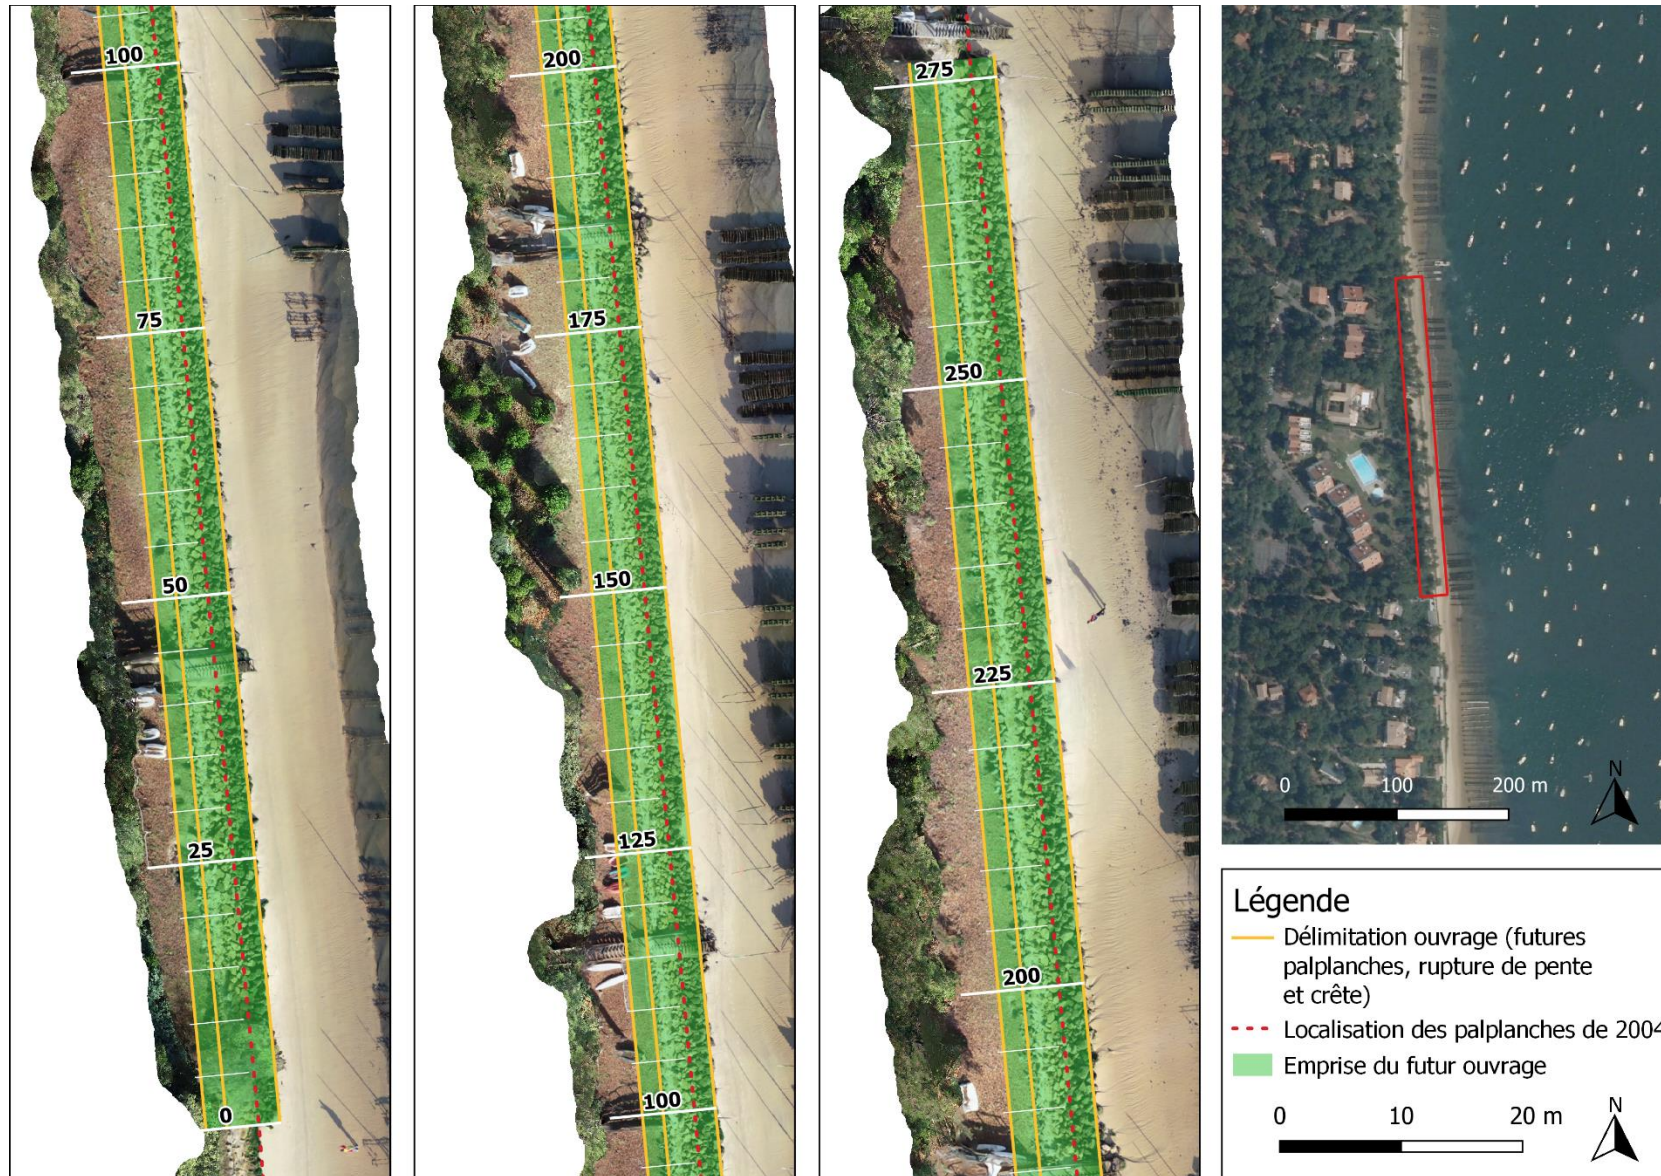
Vue en plan de l'emprise du futur ouvrage (en vert), en comparaison à l'ouvrage actuel
